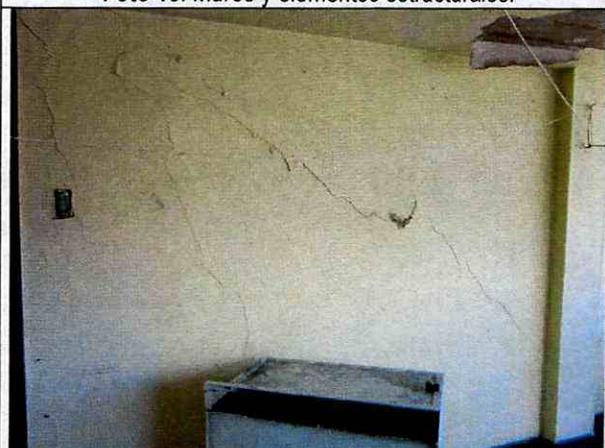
Agrietamientos en muro de tercer nivel.
